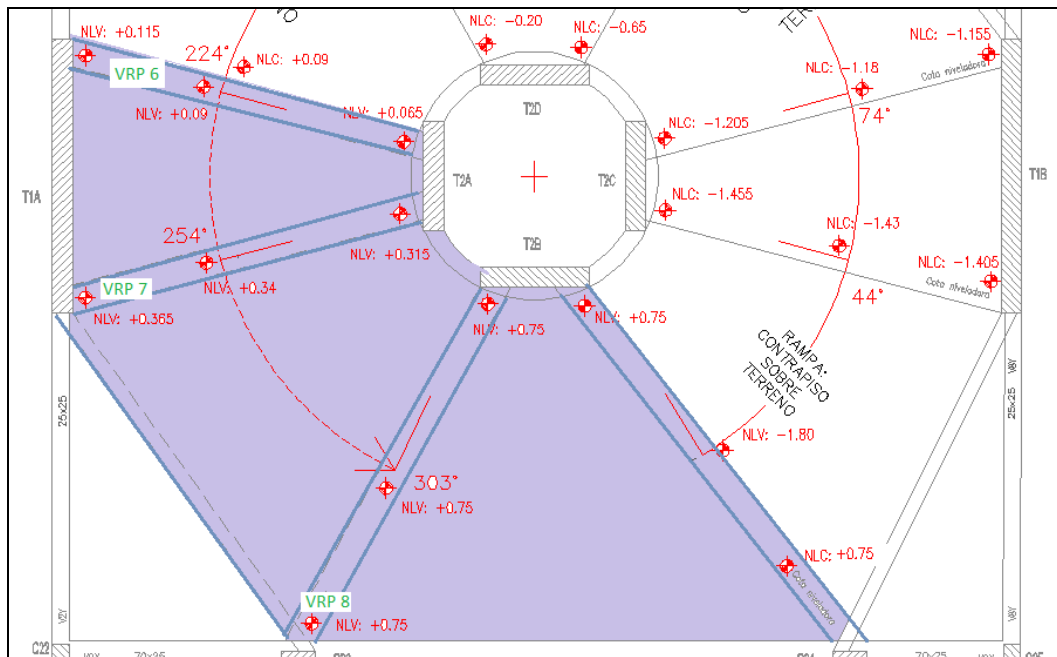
Vista en planta de la rampa helicoidal de circulación (en color gris el sector de la losa inclinada).
